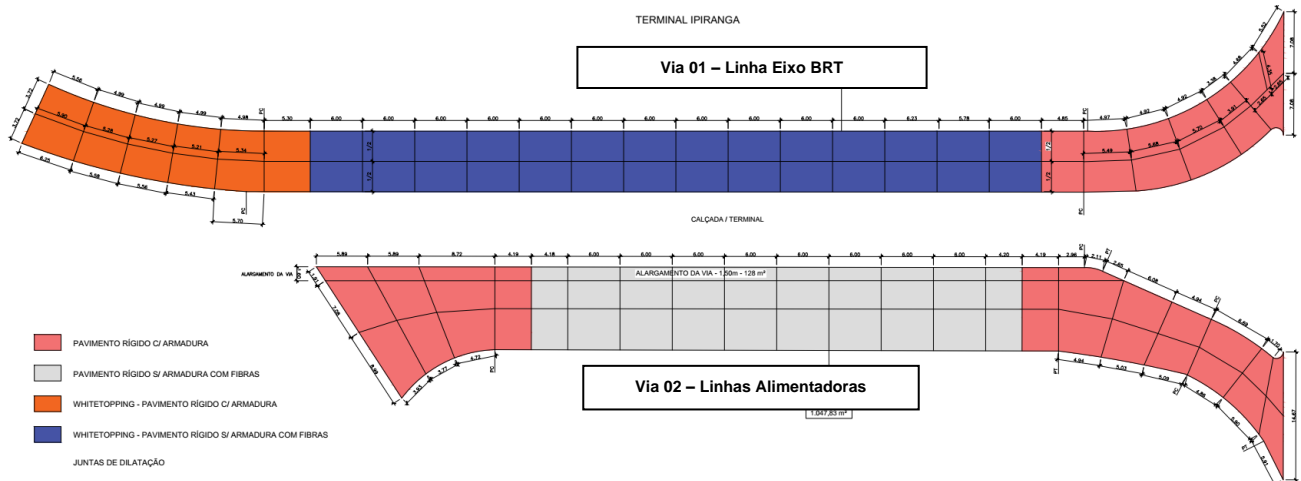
Imagem da caracterização do pavimento rígido das duas faixas de tráfego (As built – Pav Rígido Ipiranga.pdf - revisão “01”).
